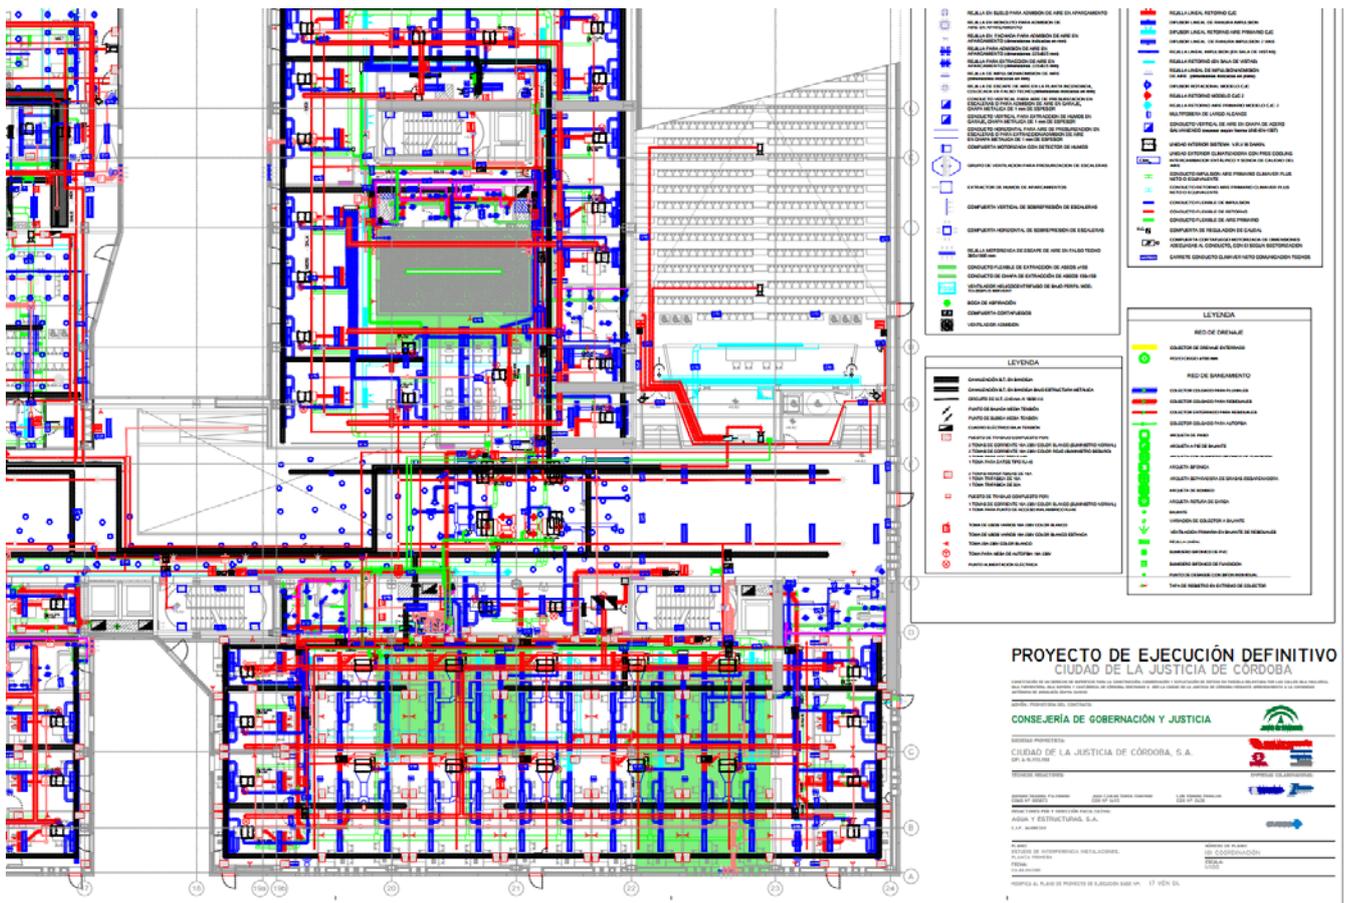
Detalle del plano de coordinación de las instalaciones MEP y arquitectura (planta primera, M4).
